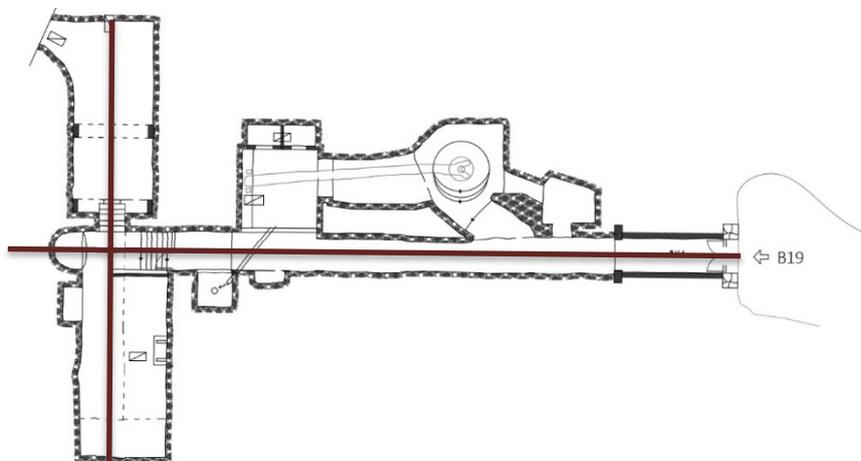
Planta bodega SRH_B19. Escala: 1/400. Fuente: *Elaboración del autor.
